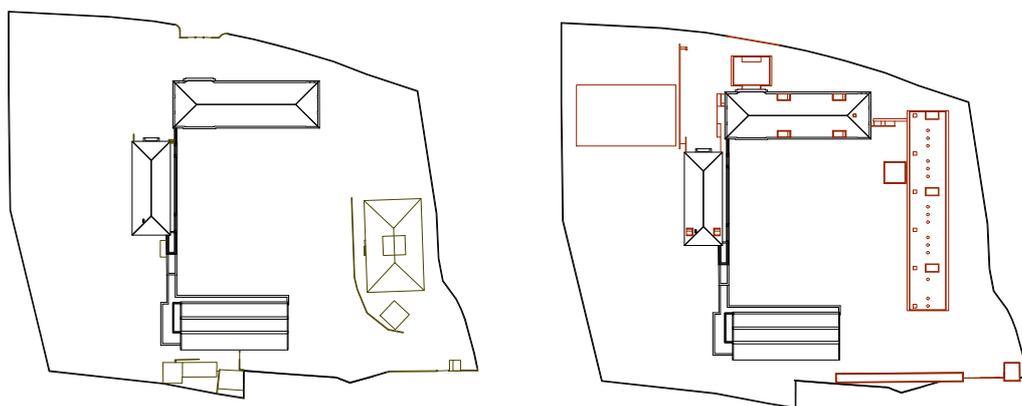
Demolição | Construção Nova - Planta de cobertura
